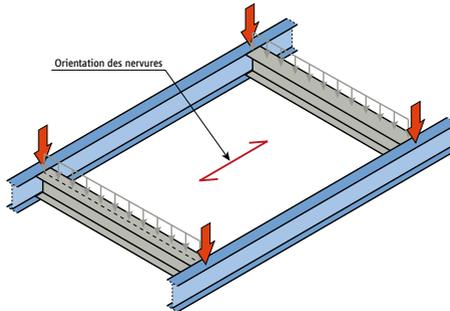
Reprise et transfert des charges réparties sur une dalle pleine
